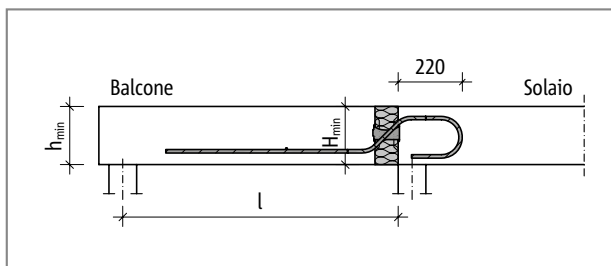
Schöck Isokorb® tipo da Q40M a Q60M: schema statico
